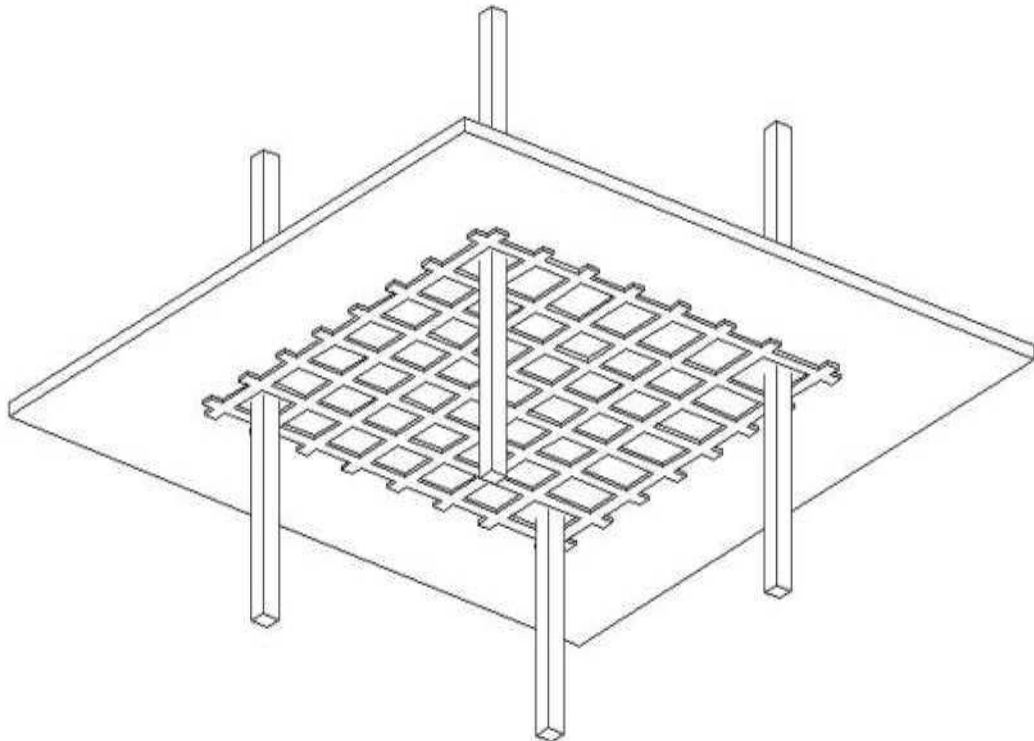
Схема наклеювання углепластика на нижню поверхню плити
